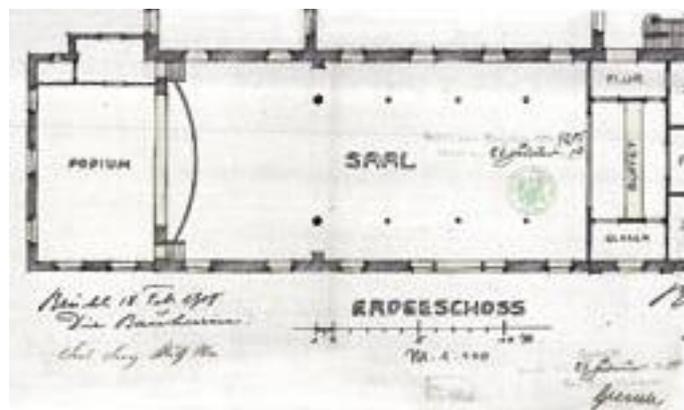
Erdgeschossgrundriss von 1908 (Ausschnitt), Comessastraße 42
